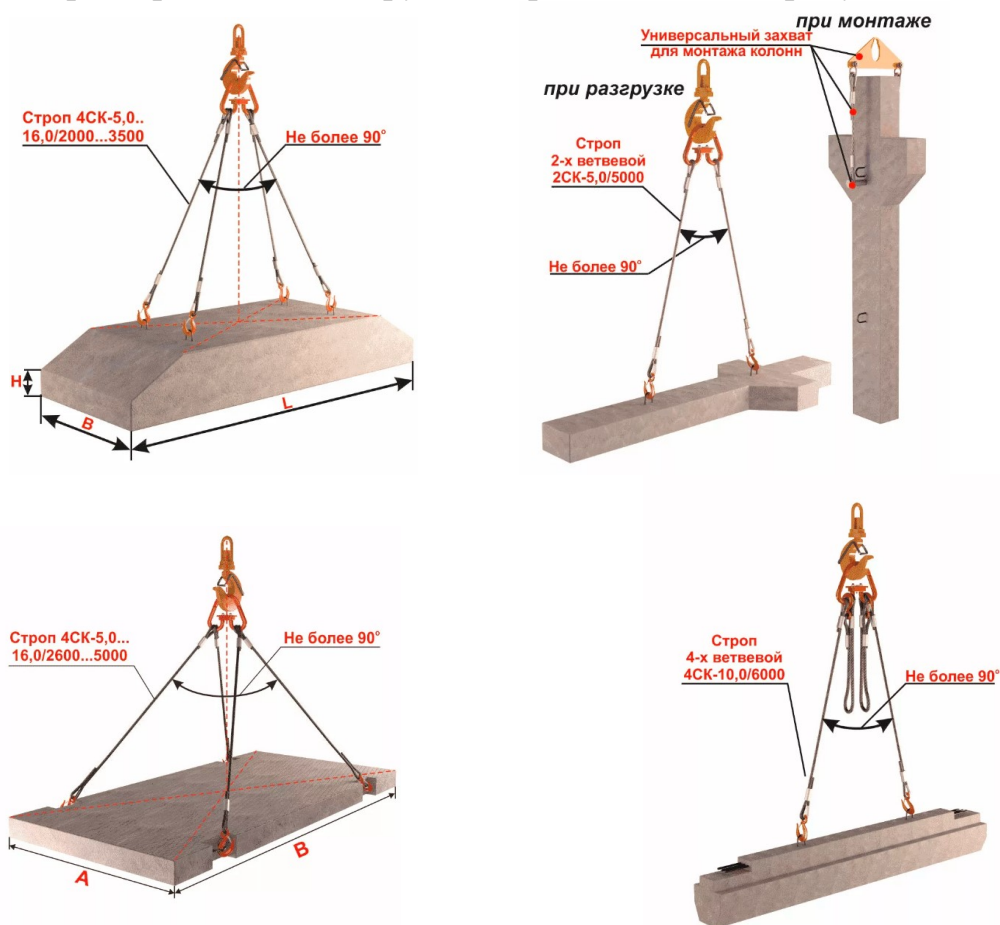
Схемы строповки конструкций при разгрузке (монтаже)
